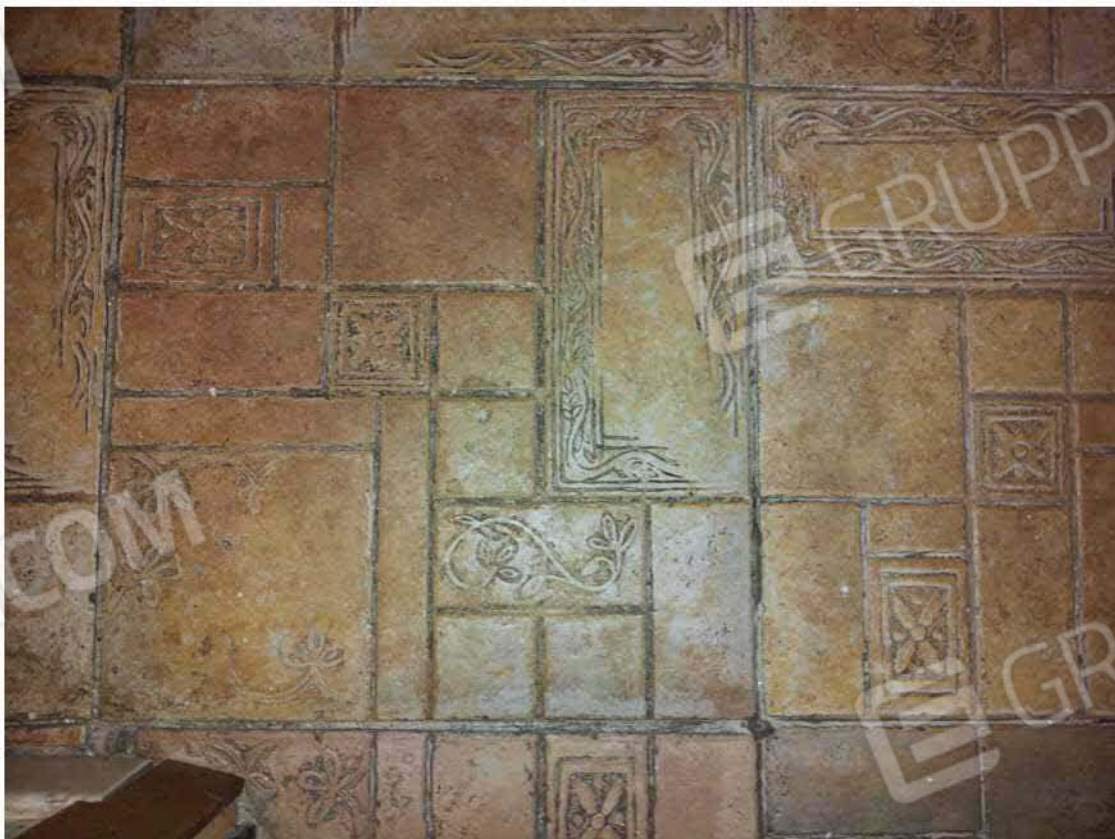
Unità immobiliare in traversa di via Padolisi: pavimentazione delle stanze da letto.
